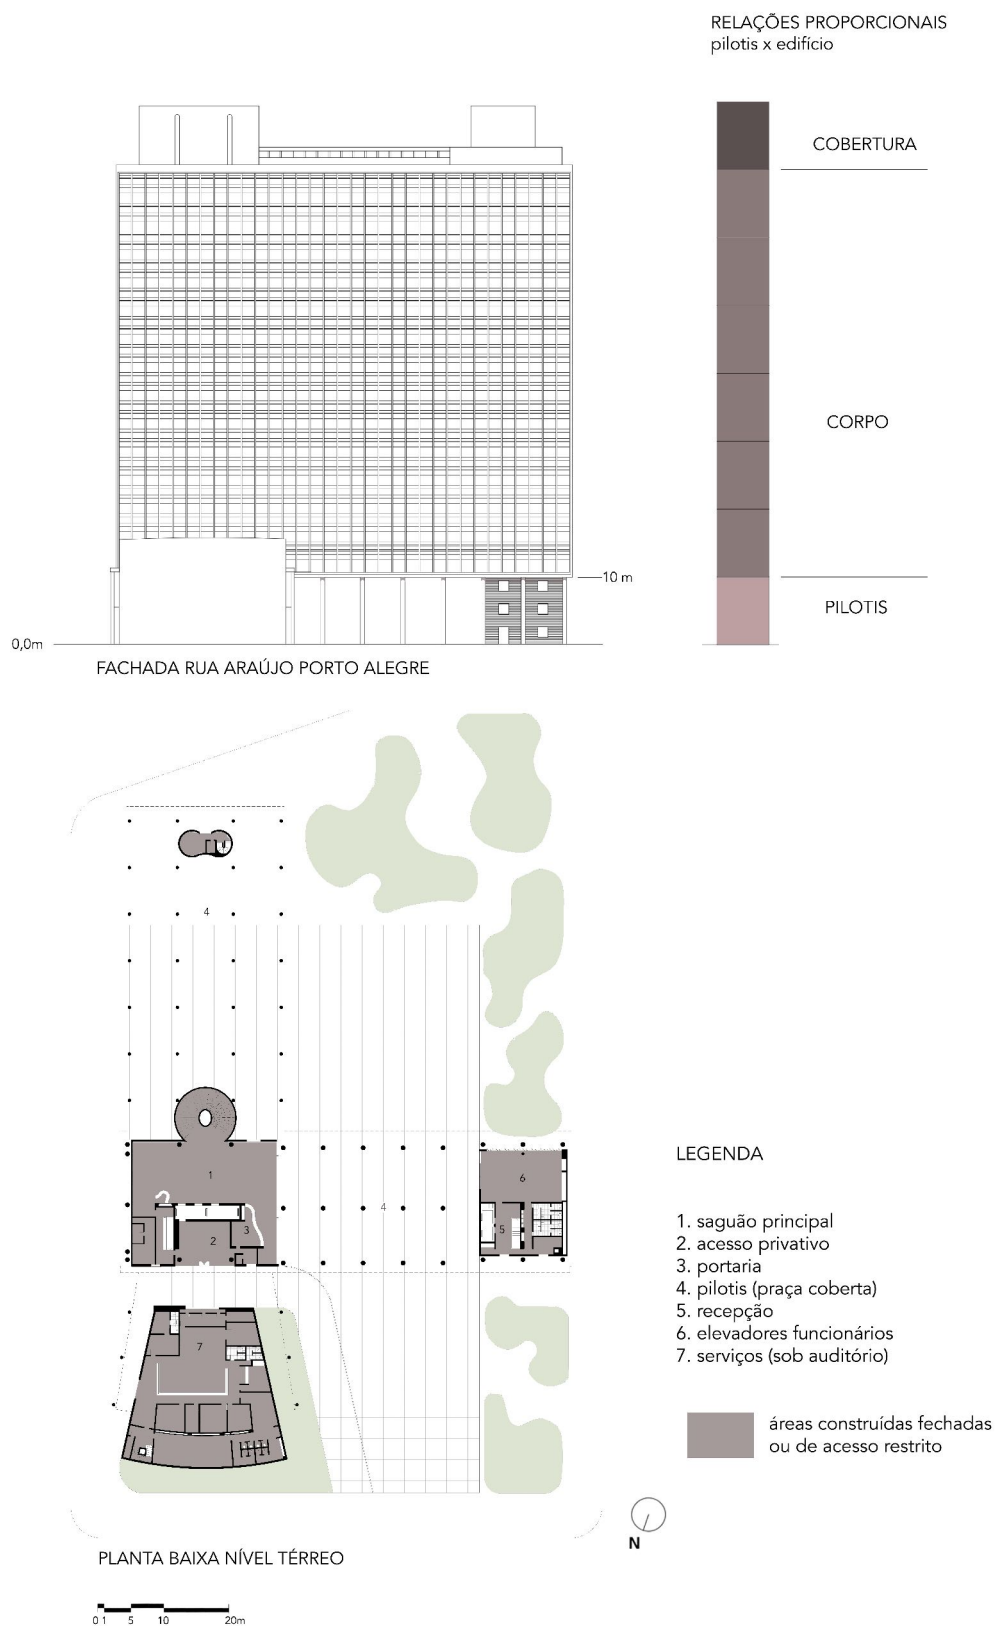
Planta baixa do nível térreo e fachada principal do MES.
